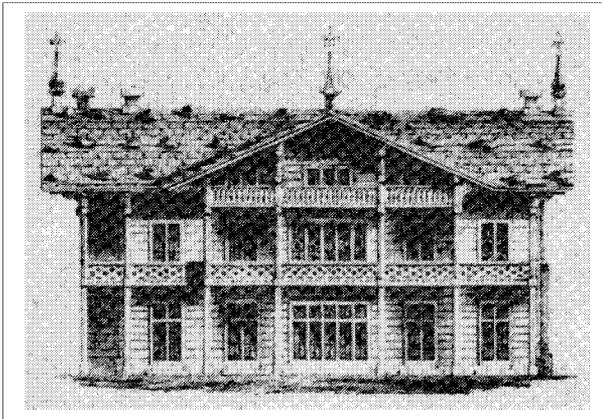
„Das Schweizerhaus“, Projekt für ein Schweizerhaus auf der Insel Rügen von C. F. Schinkel,
